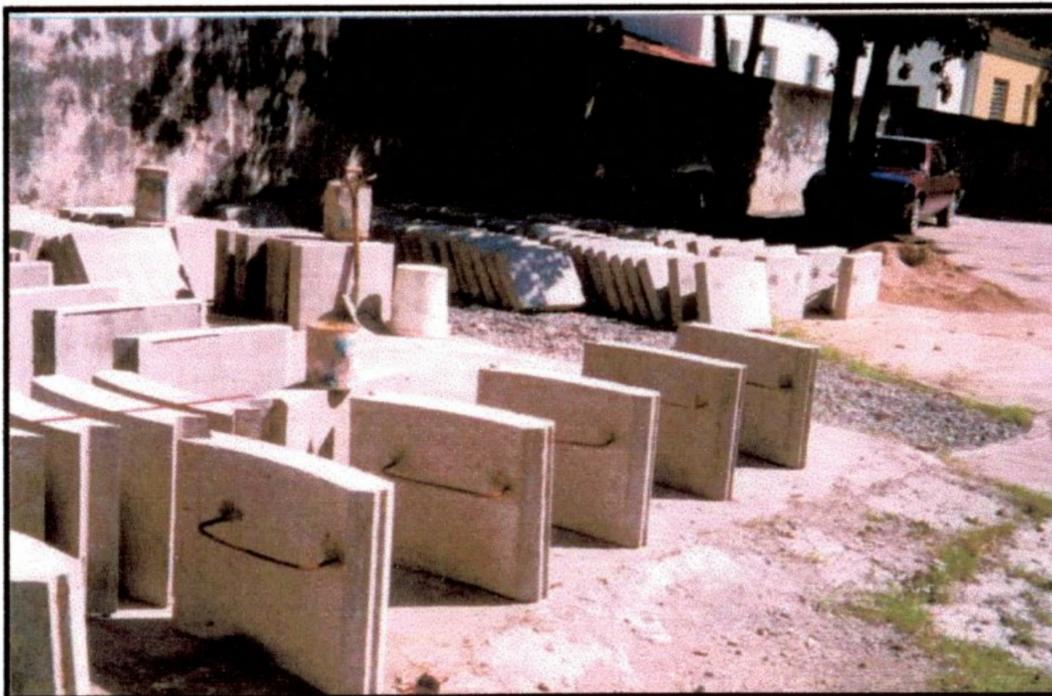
Blocos especiais com estrutura metálica para suporte de escada.
